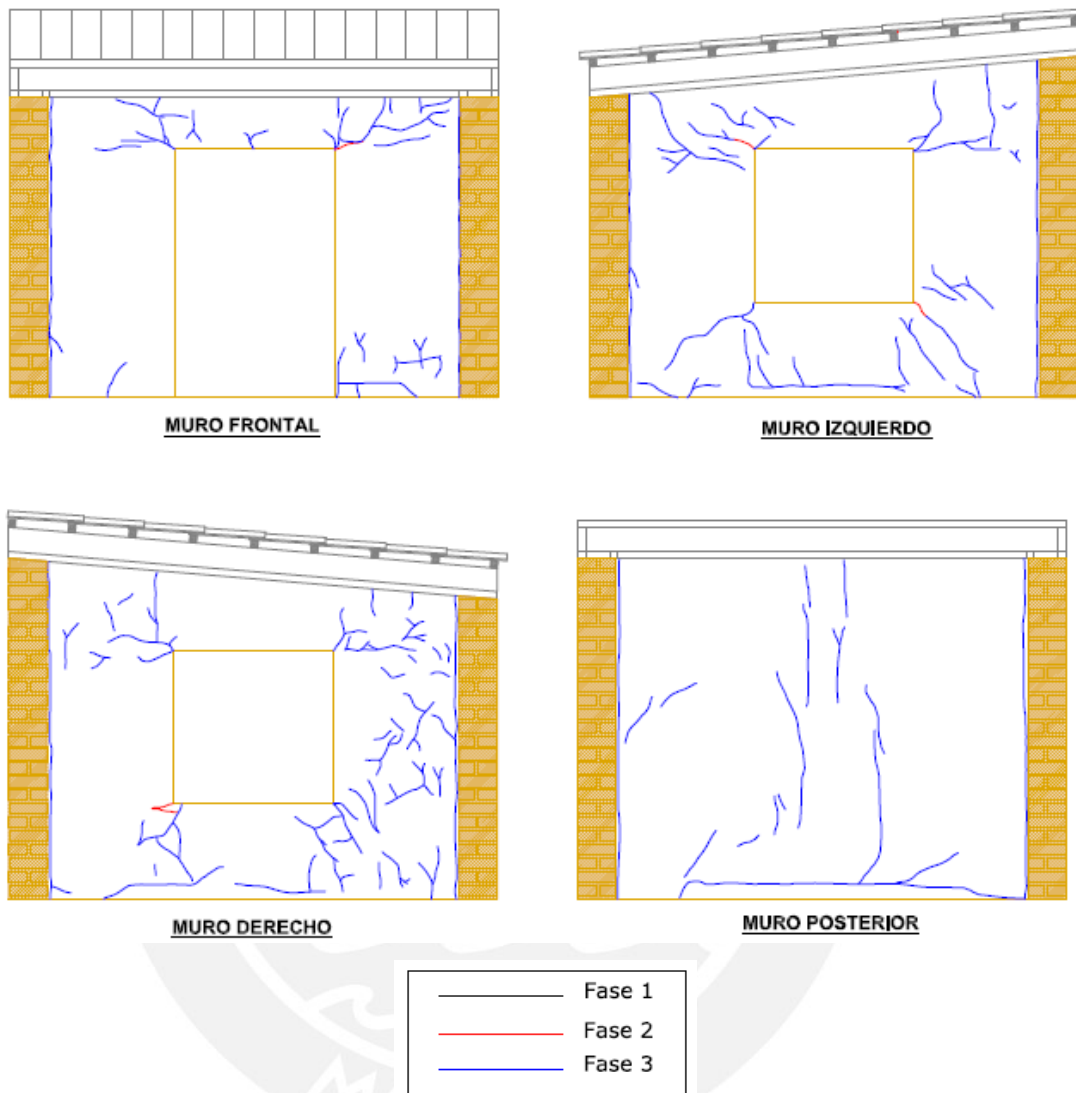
Fisuras en tarrajeo interior – Módulo M100-T4100D
